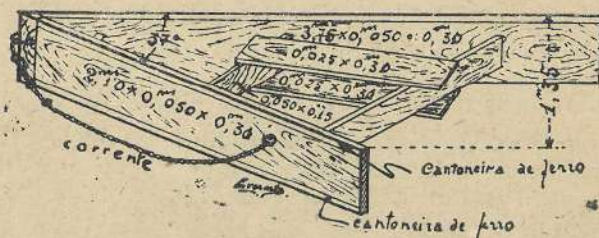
Draga em V. Conforme o engate da tração na corrente a draga remove maior ou menor faixa de terreno.
